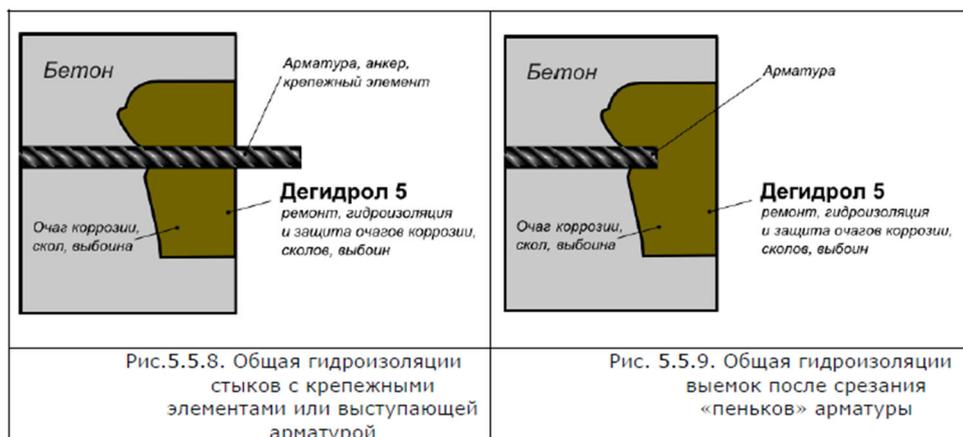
Общая гидроизоляции стыков с крепежными элементами или выступающей арматурой
